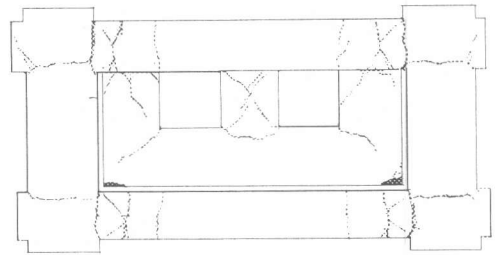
WO-FRAMEのひび割れ状況(R=4%)
